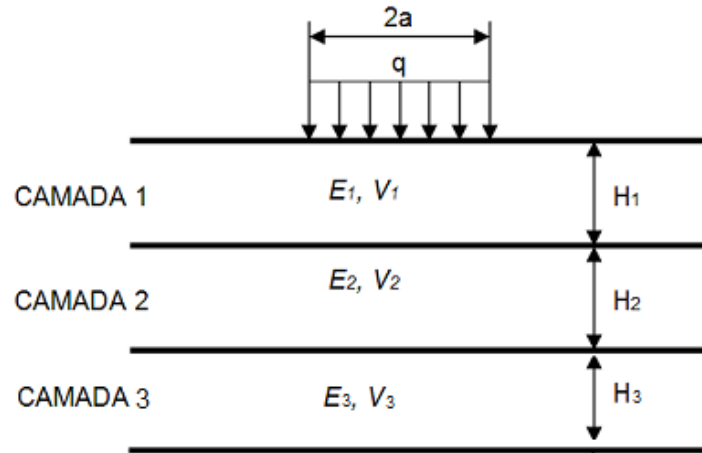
Esquema de pavimento para diversas camadas (Huang, 2004, adaptado)
